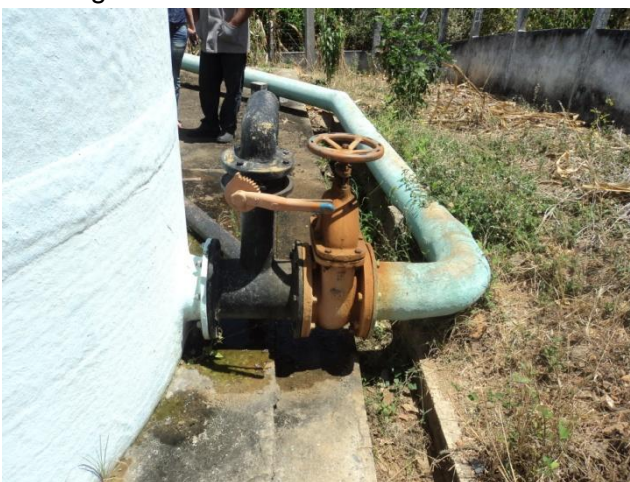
Filtro 3: tubulação de descarga quebrada com vazamento.
